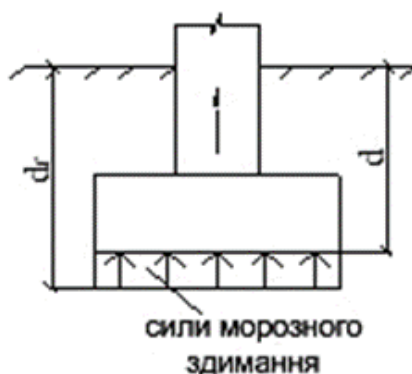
Схеми морозного здимання основи: d_f –глибина сезонного промерзання ґрунтів; якщо $d < d_f$ – фундамент піднімається
